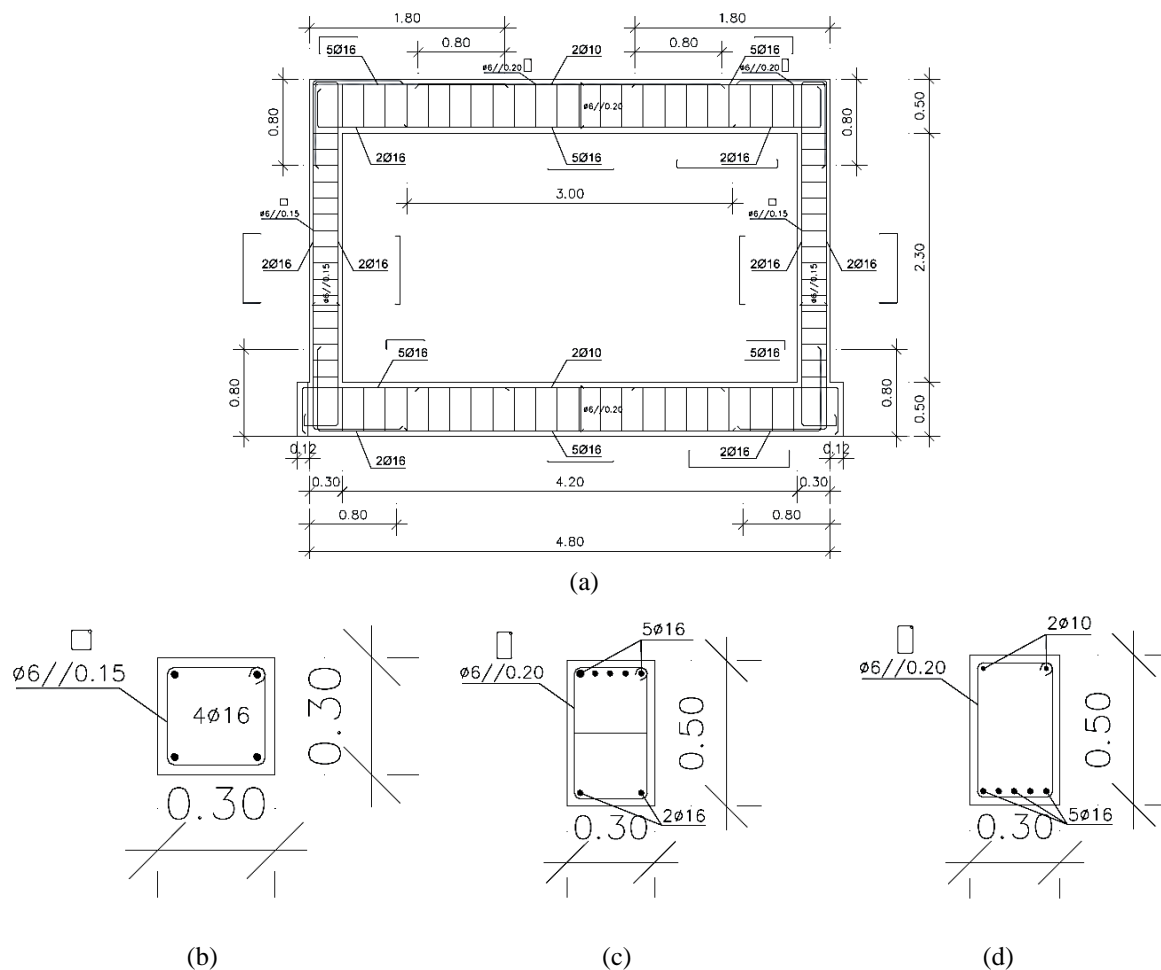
Pórtico de Betão Armado - Geometria e Detalhes das Armaduras (a) Esquema Global (b) Secção Transversal do Pilar (c) Viga – apoio (d) Viga – meio vão (adaptado de [19])
